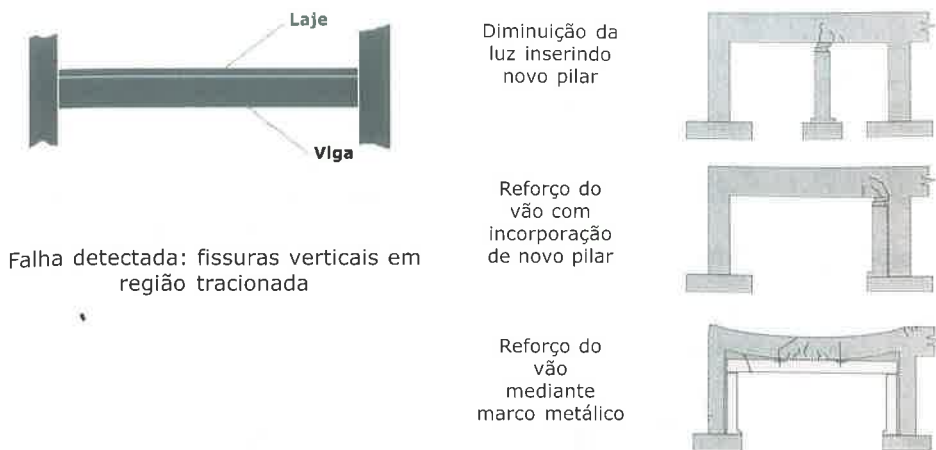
Reforço de concreto estrutural – suportes.
